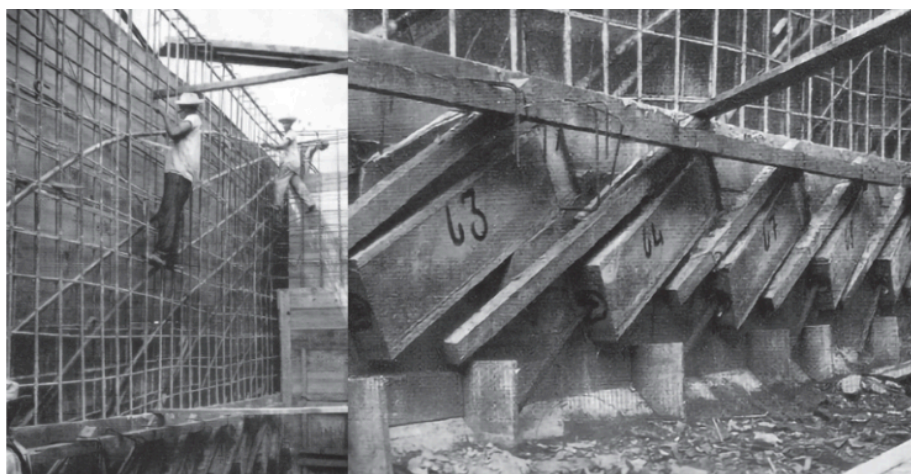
Foto da execução e locação dos cabos de protensão dentro da viga.
